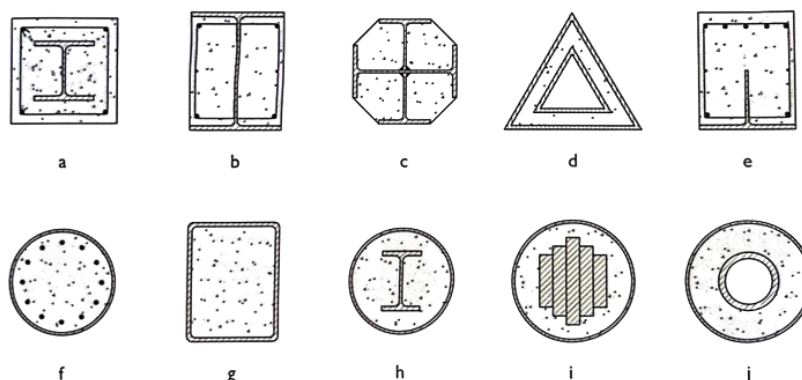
Exemplos de secções transversais de colunas mistas [1].
